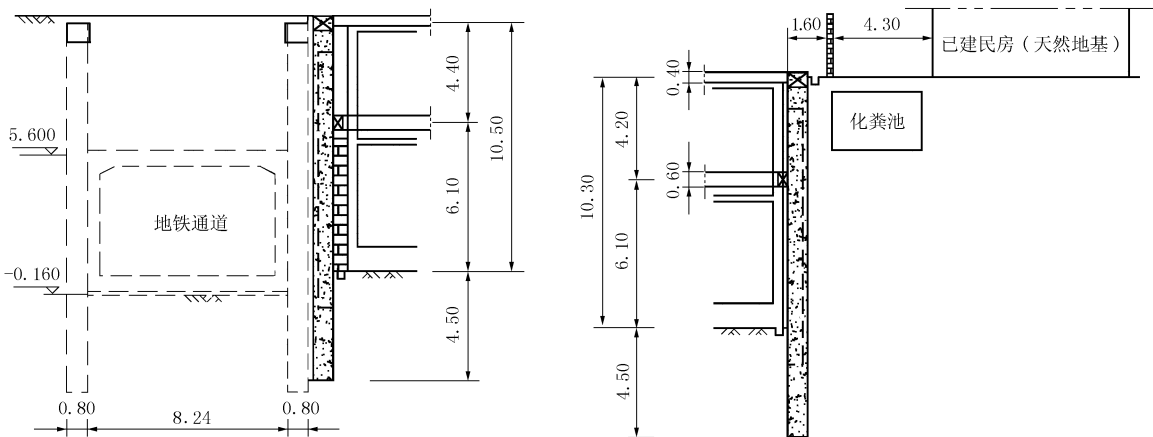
基坑南北侧排桩内支撑支护剖面图(单位:m)
